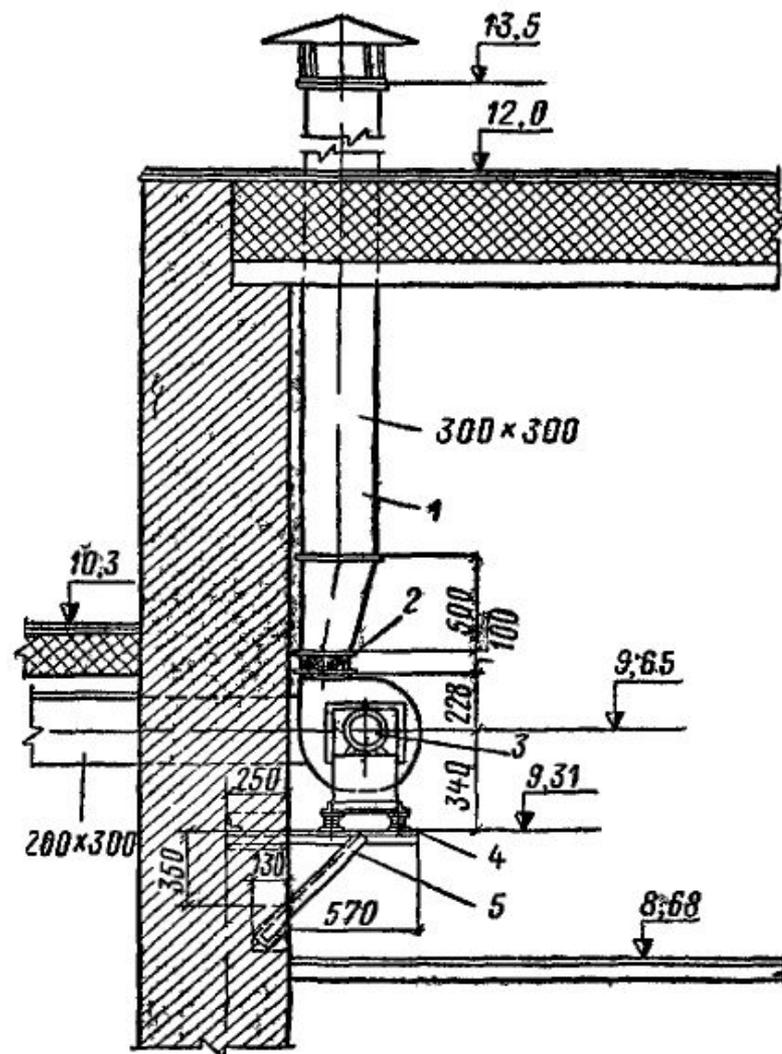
Вытяжной вентилятор, размещенный на кронштейне
